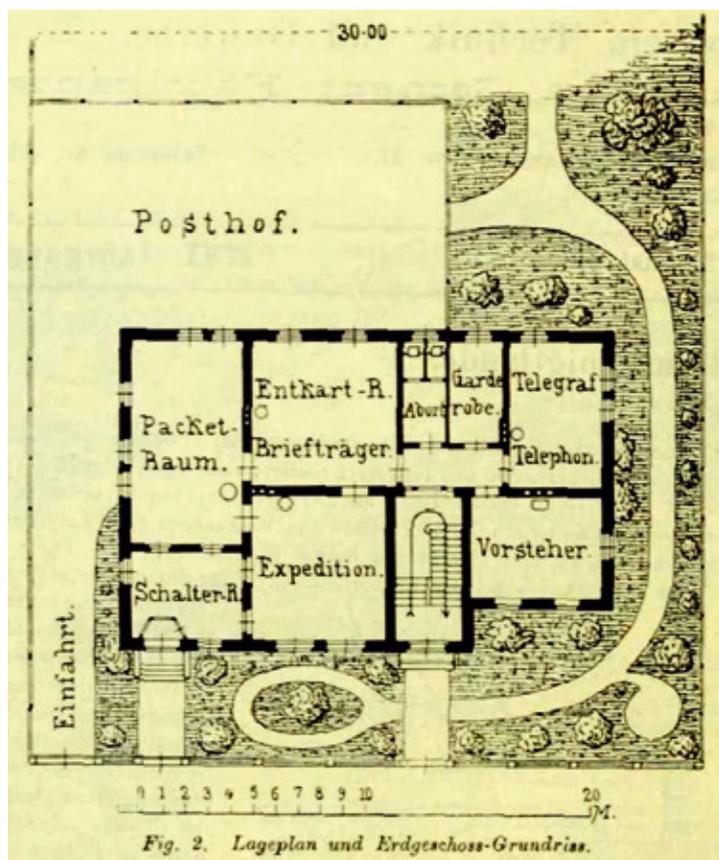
Lageplan und Erdgeschoss-Grundriss.
